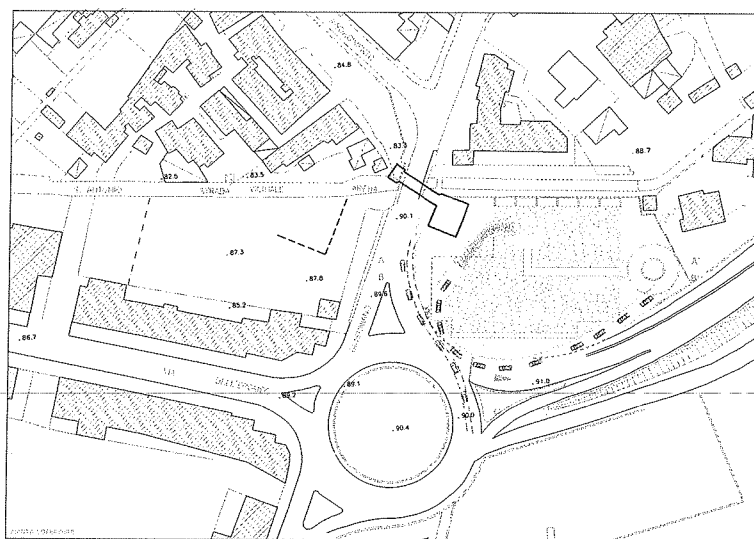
Planimetria dell'area interessata dalla costruzione del parcheggio di Via Giustiniano
